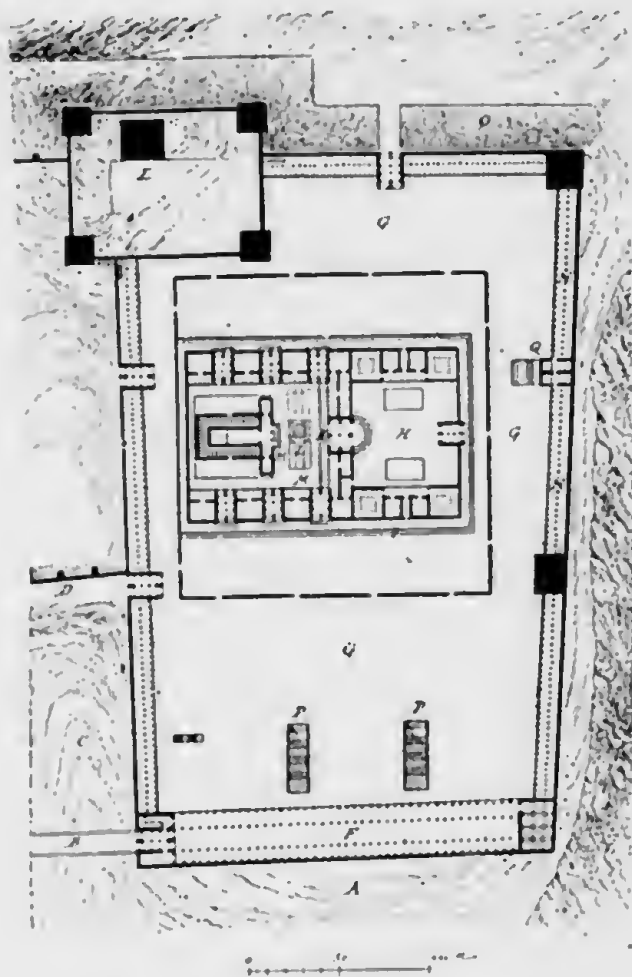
Plan du temple d'Hérode (d'après M. de Vogüé)¹.
